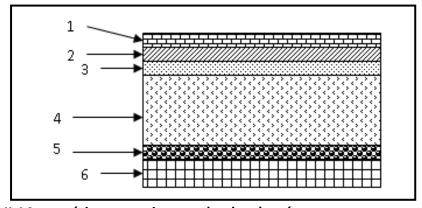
matériaux constituants du plancher étage courant en corps creux
